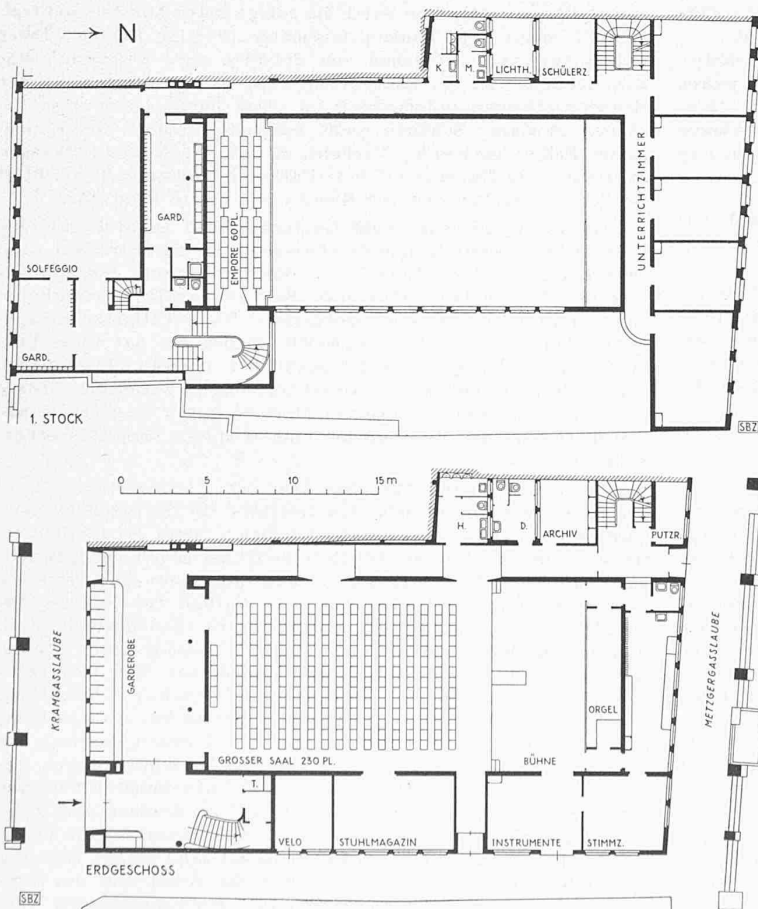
u. 2. Grundrisse 1: 400 des Konservatoriums in Bern
